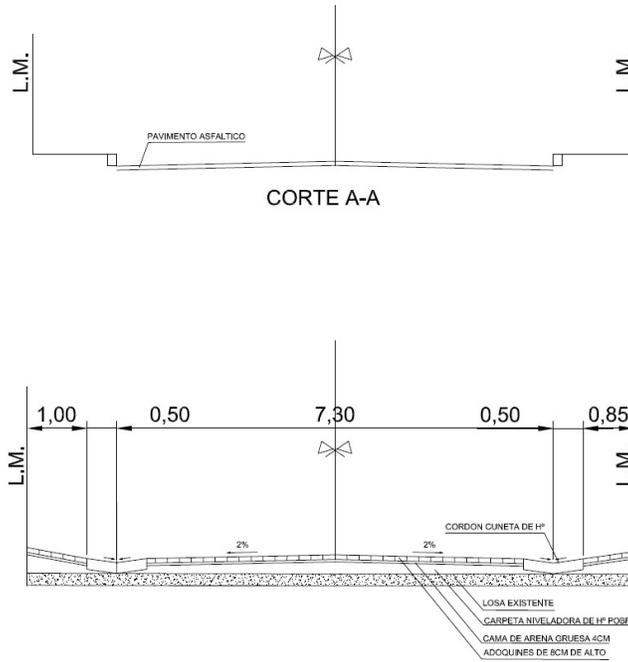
Detalle de los cortes A-A y B-B en la nueva calzada de calle Derqui.
